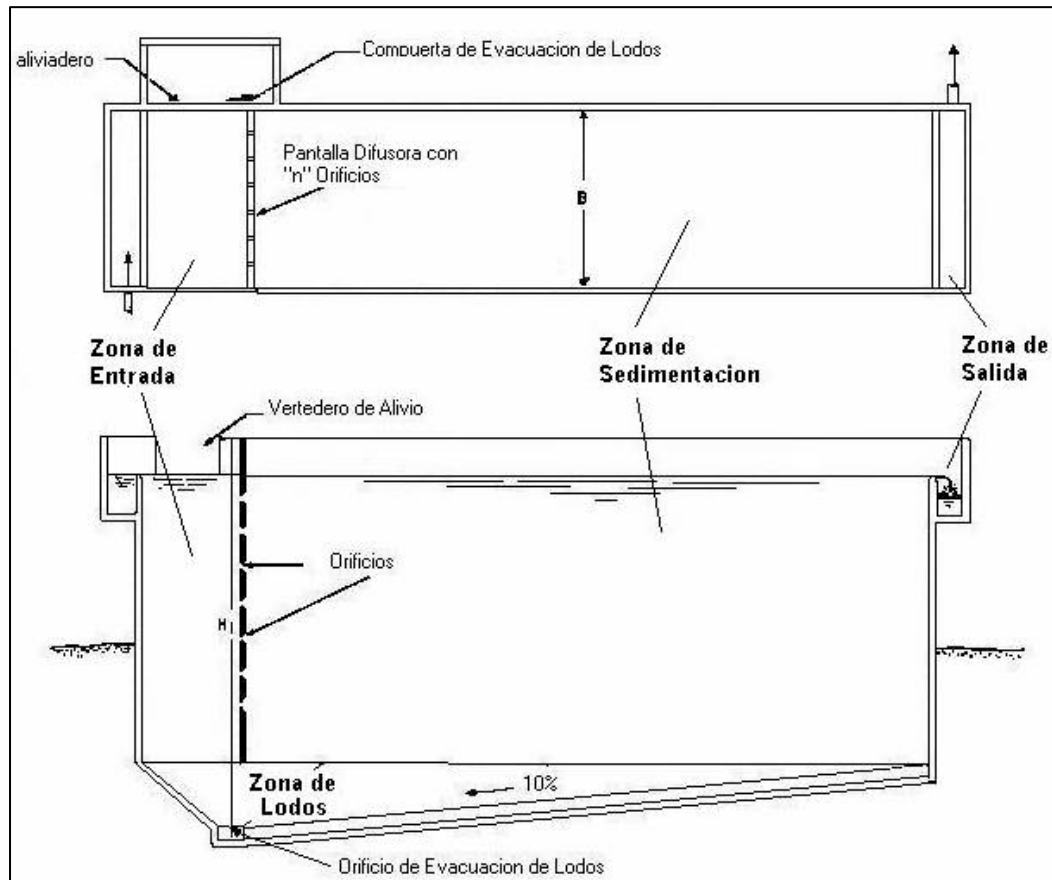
Sedimentador (Planta y Corte Longitudinal).
